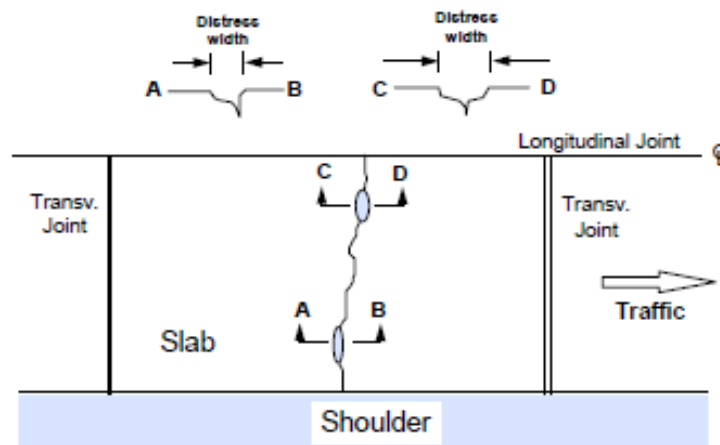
Esquema de agrietamiento transversal de losas de concreto hidráulico (JPCP).
